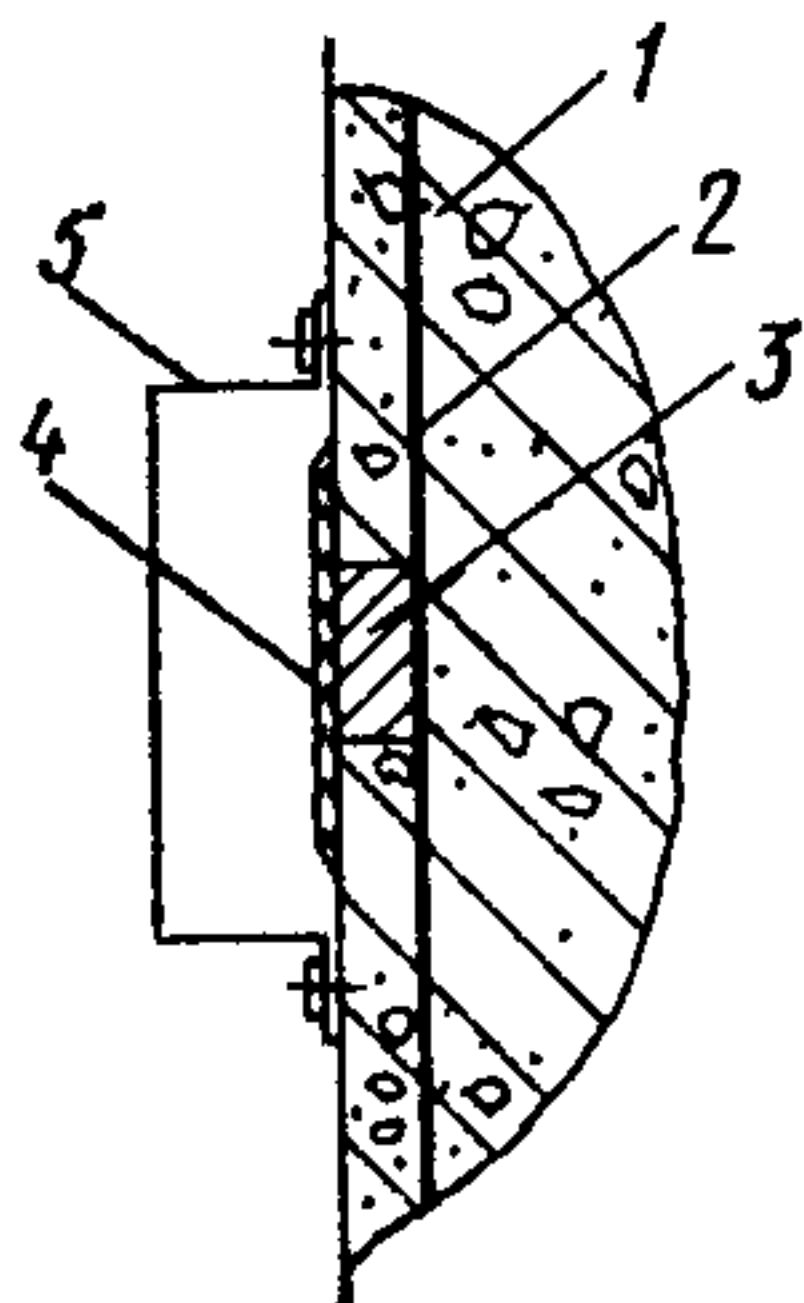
Пример устройства контрольно-измерительного пункта в надземной железобетонной конструкции
